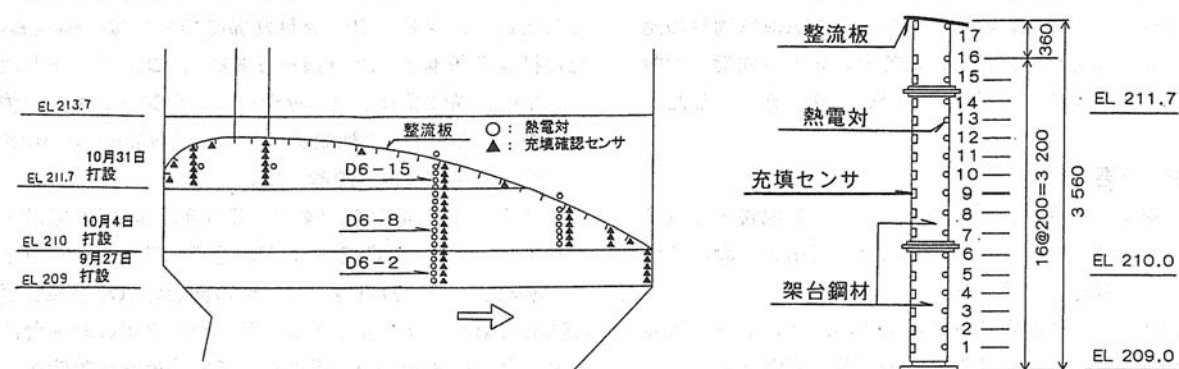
熱電対およびコンクリート充填センサの設置位置
